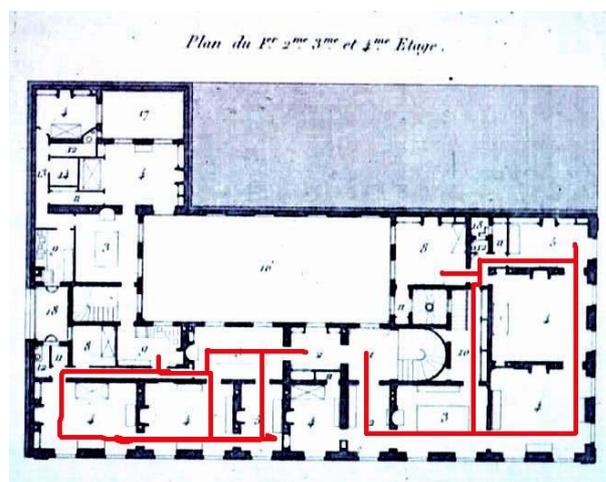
Planta baixa dos pavimentos. Em vermelho as circulações internas *en enfilade*.
